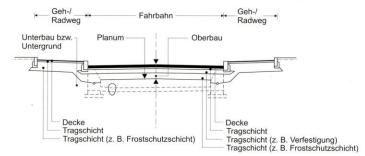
Beispielhafter Aufbau einer Befestigung in geschlossener Ortslage mit teilweise wasserundurchlässigen Randbereichen sowie mit Entwässerungseinrichtungen
